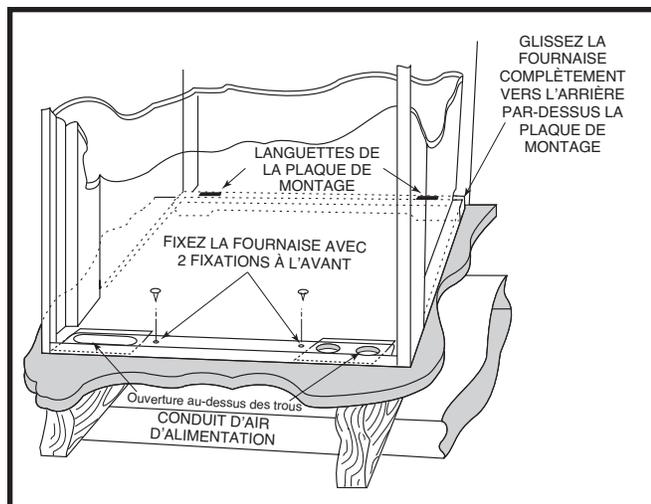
Fournaise de placard sur conduit d'air d'alimentation
